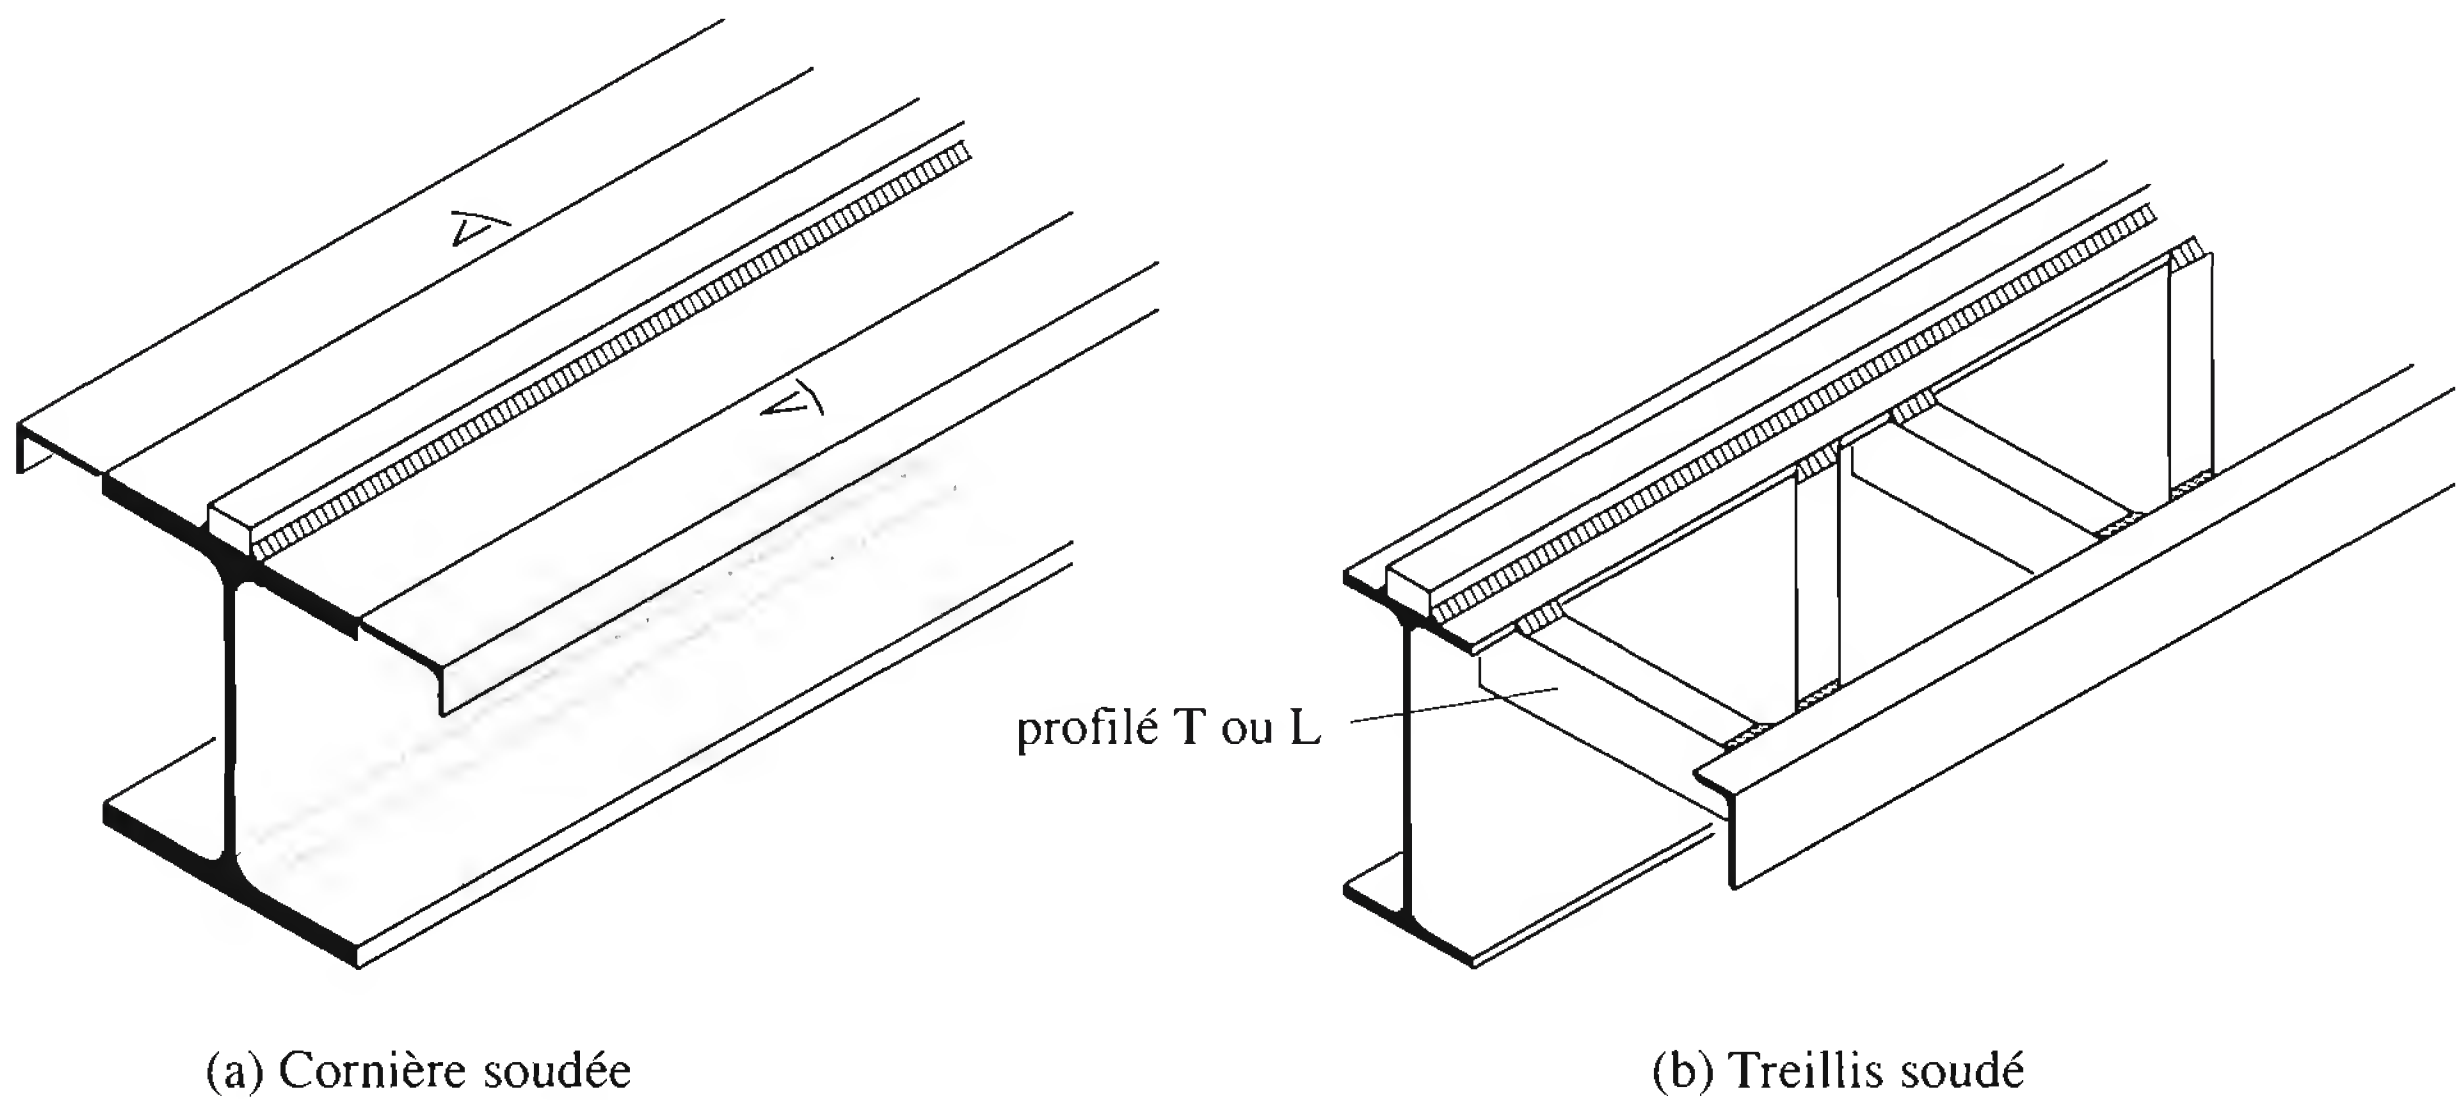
Exemples de renforcement de l'aile supérieure d'une poutre de roulement.
